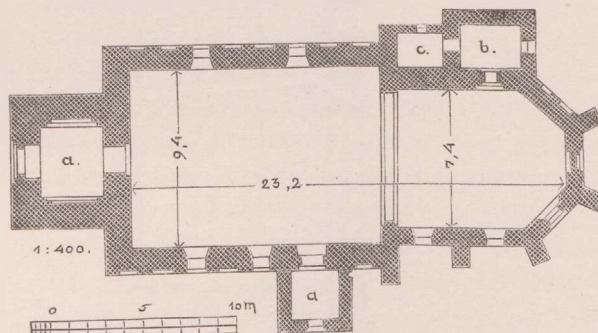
Lopatken. Grundriss der Kirche.
